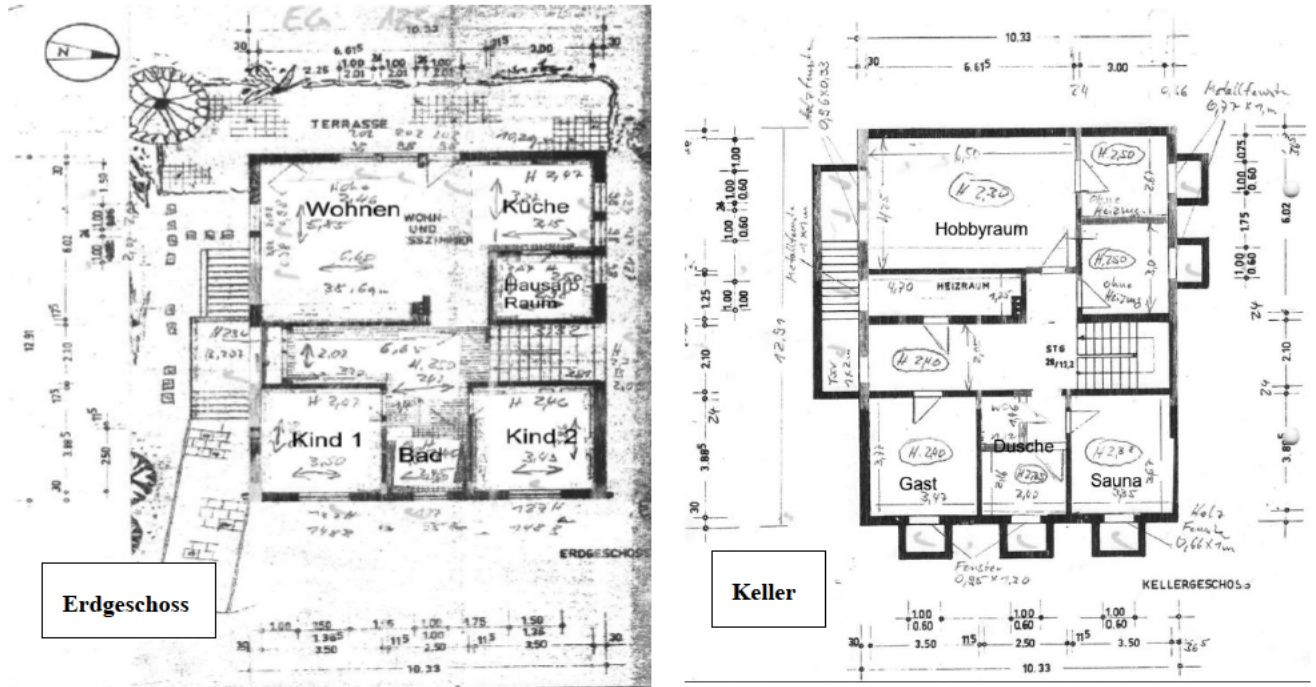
Grundrisse der Geschosse (Unterlagen des Kunden)
